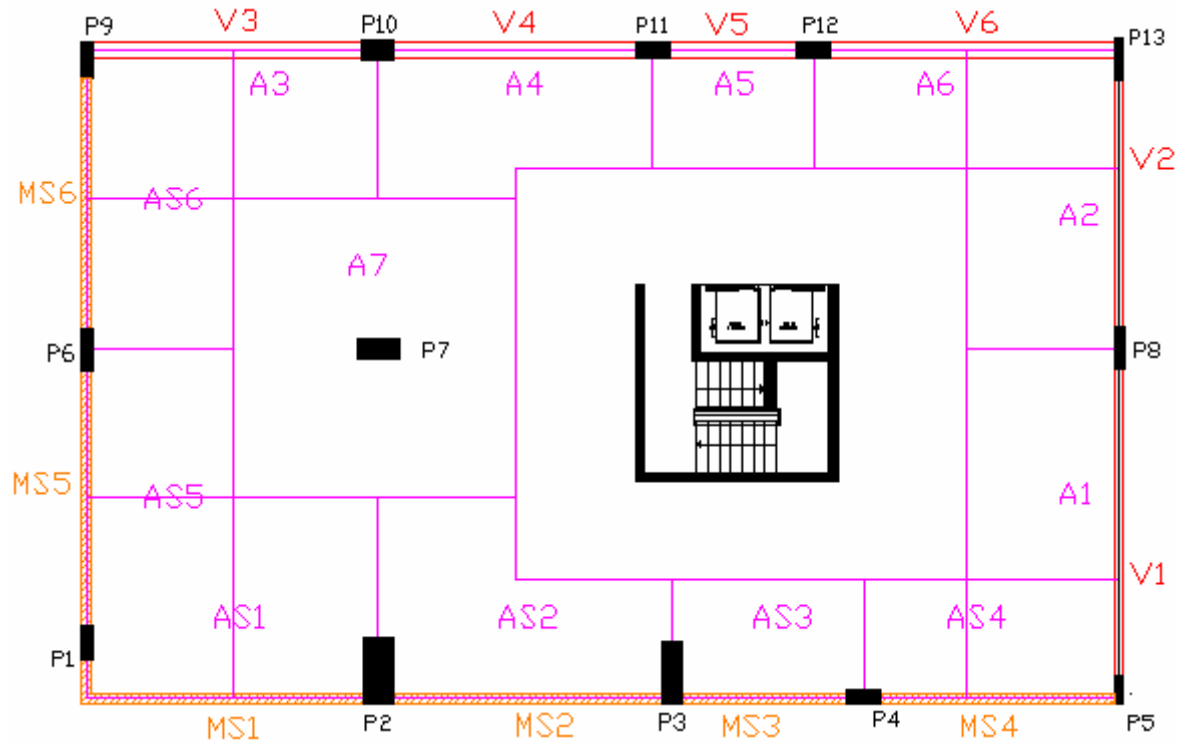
Áreas de influência das Vigas (Ai) e dos Muros de Suporte (ASi) na Cave -1
